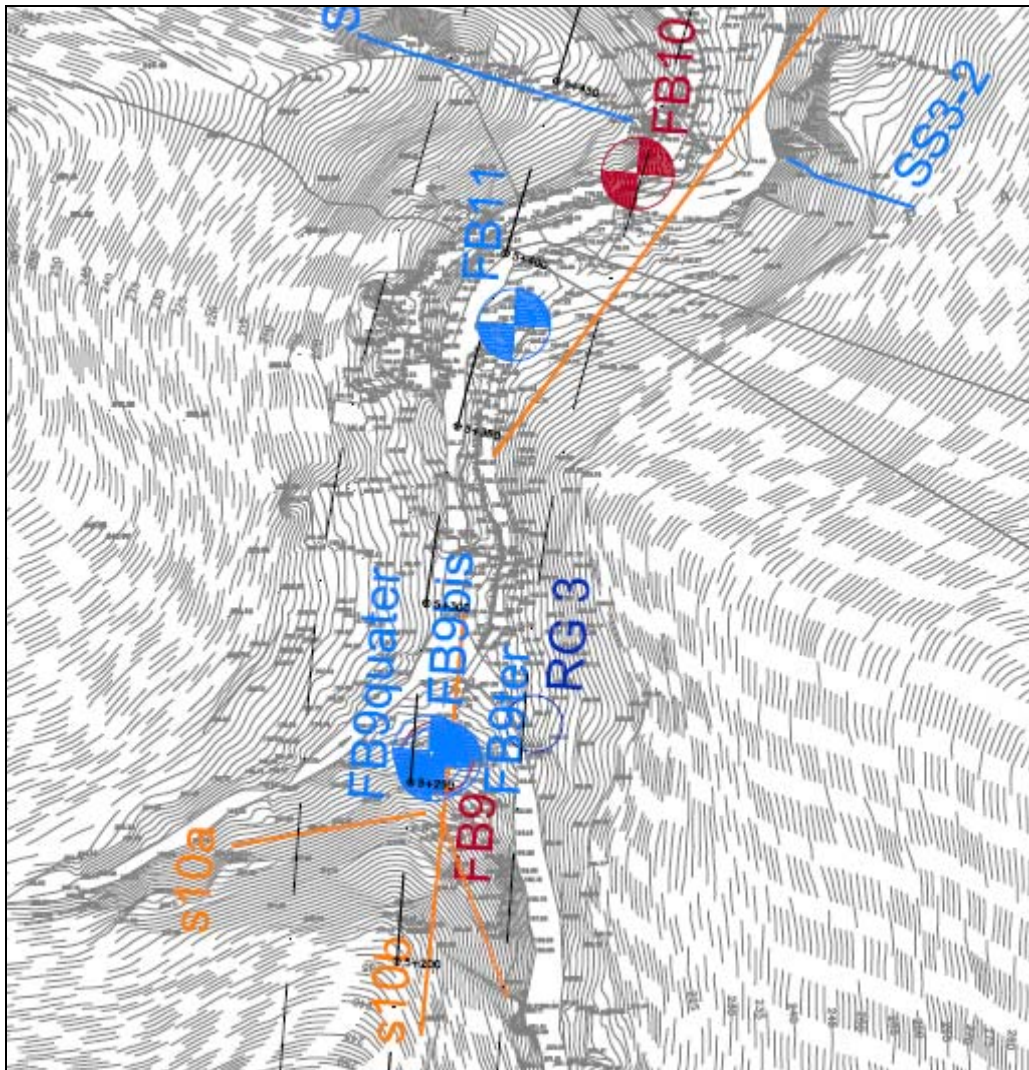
Stazione di Fontanabuona e Rotatoria di Aveno - Planimetria di ubicazione delle indagini – Tavola 2
